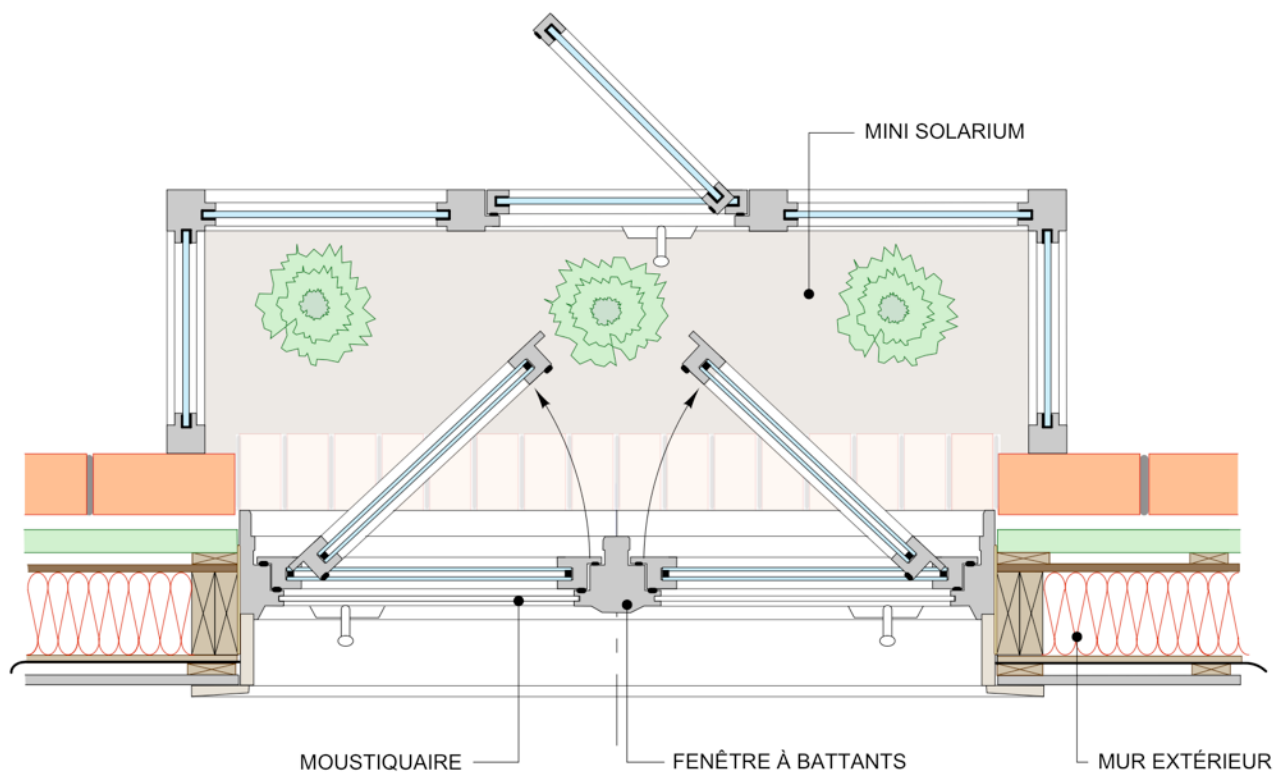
b : Exemple d'ajout d'un mini solarium devant une fenêtre à double battant
